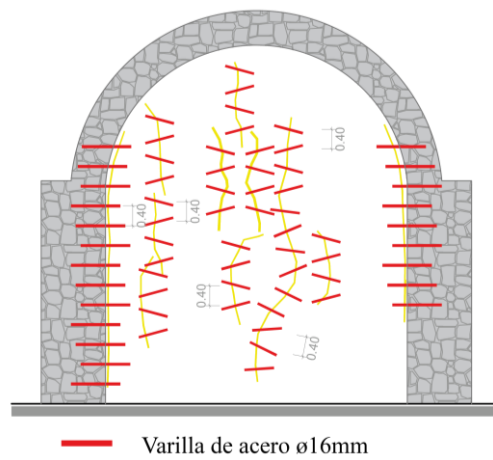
Vista de grietas y fisuras en corte E-E'
